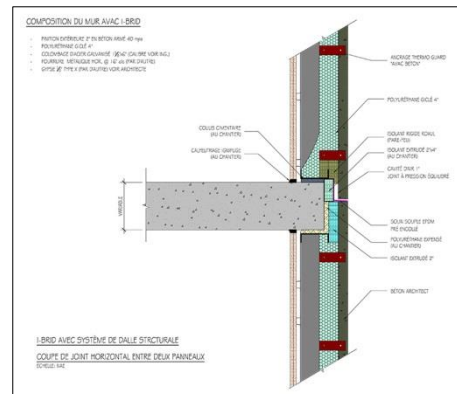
(3.5):Coupe joint horizontale entre deux panneaux
